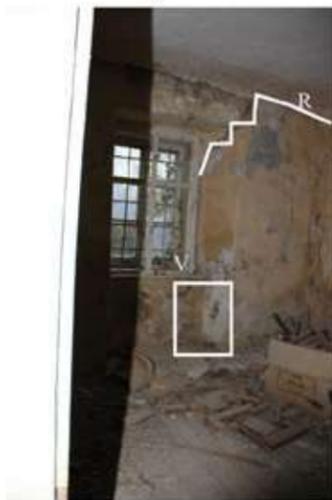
Lage im Erdgeschoss, Südöstliche Ecke des Zimmers mit Putzverfärbungen, Fenster Ostwand, Kaminöffnung Westwand, Walzenmalerei Decke, Abfallender Putz der Schilfrohrdecke und grüner bzw. dunkelblauer Wandanstrich
